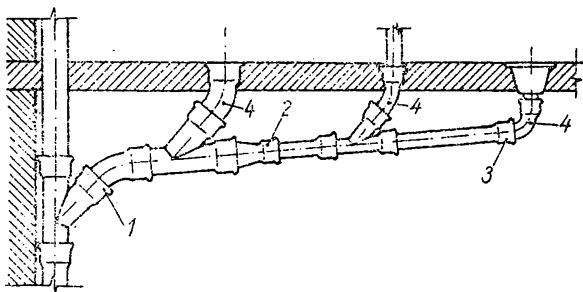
Montarea conductei de legătură sub planșeu :
